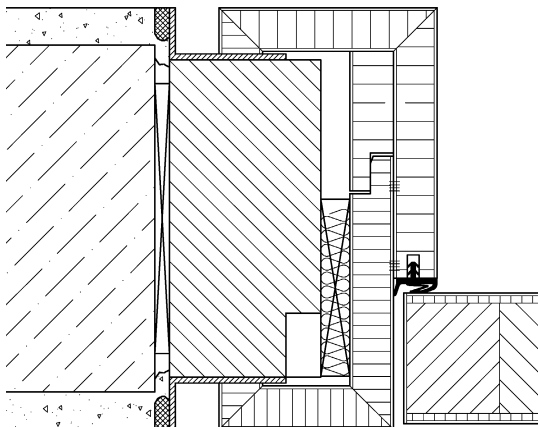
Block-Zarge B60/75 mit Montagerahmen in Montagewand,
